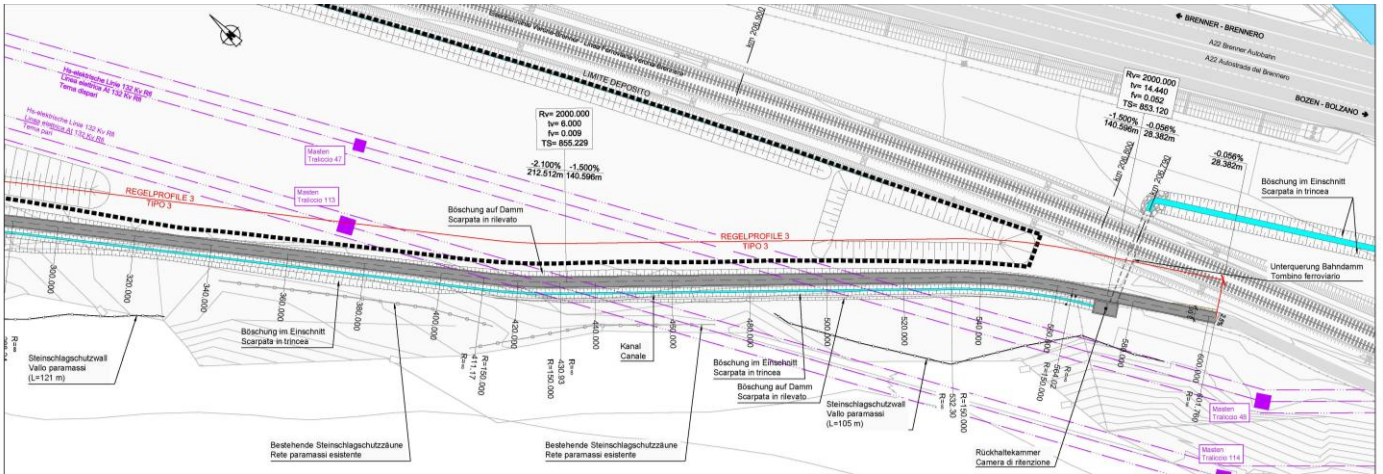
Lageplan Fahrradweg Baustelle Genauen 2 – Teil 2
